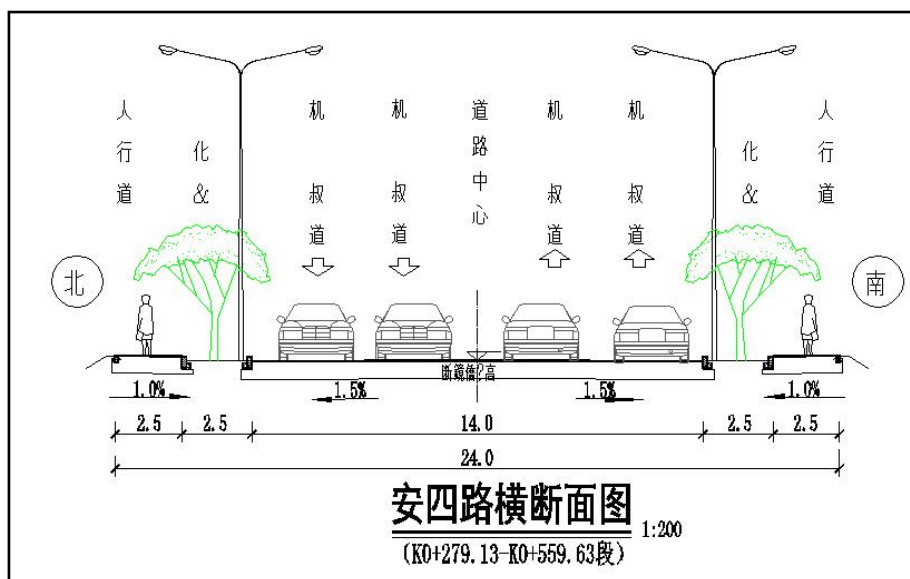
施工图阶段安四路 (k0+279-559) 段横断面方案设计图
